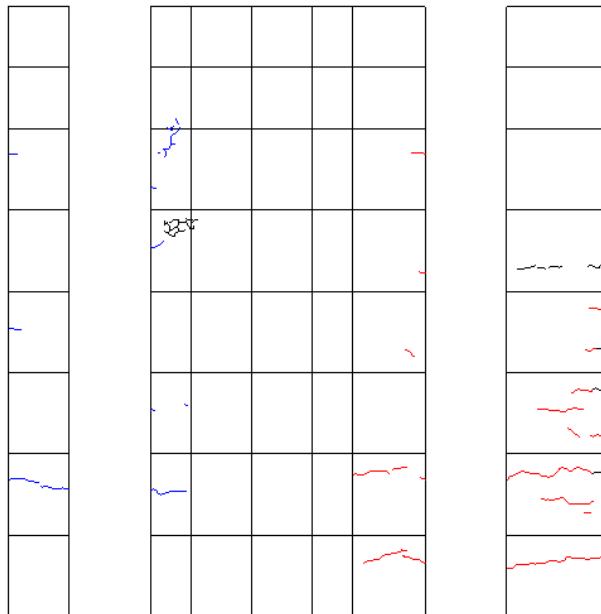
R=-1/800 ひび割れ図
